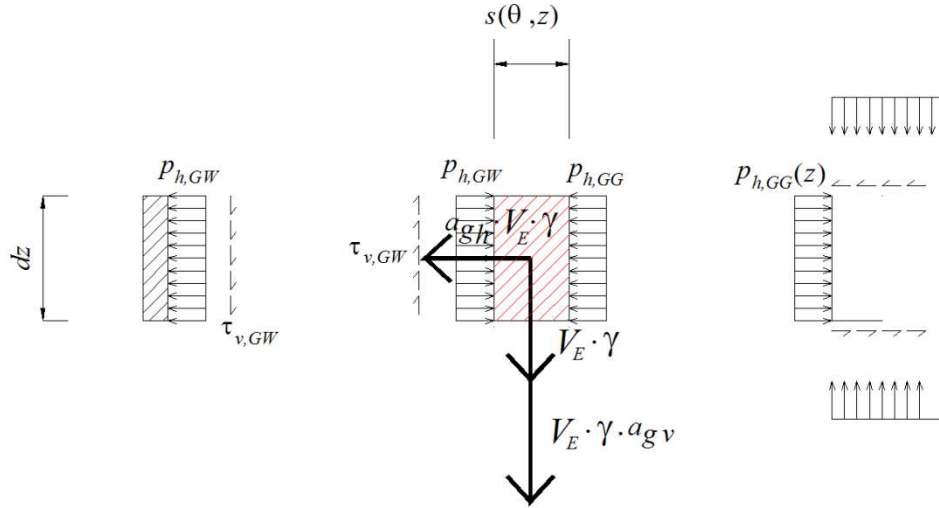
Sezione longitudinale verticale con zoom solo sull'elemento E: pressioni e azioni agenti.
